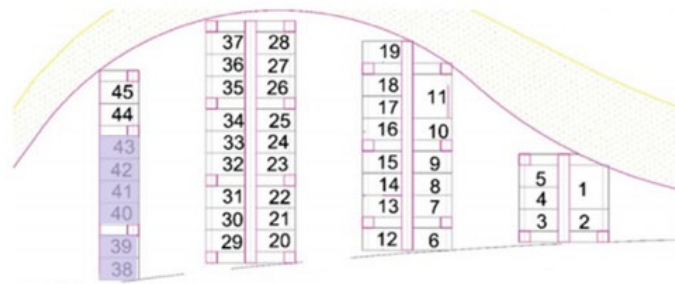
Plazas tipo (E) 38-43. Fuente propia
